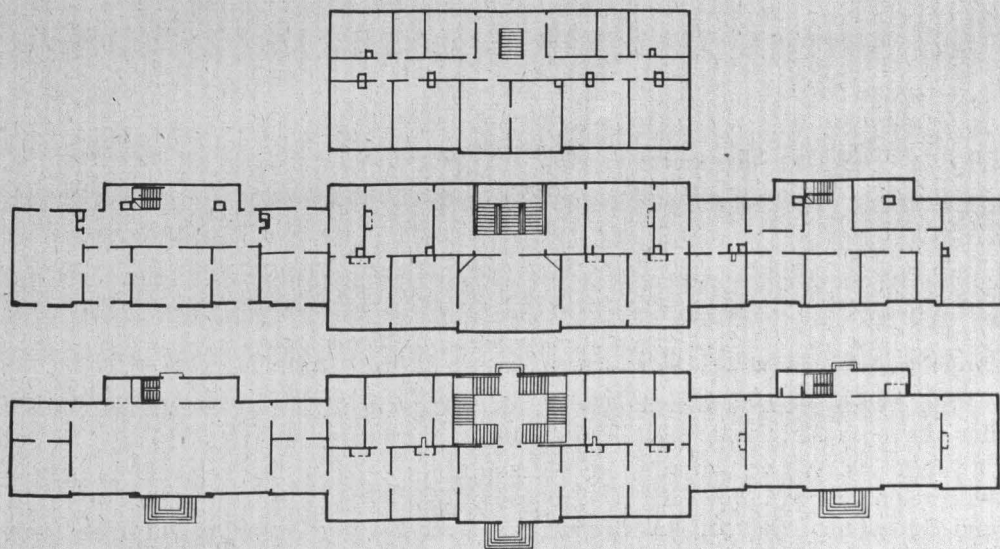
Grundrisse des Fürstlichen Schlosses zu Antoinetten Ruh
